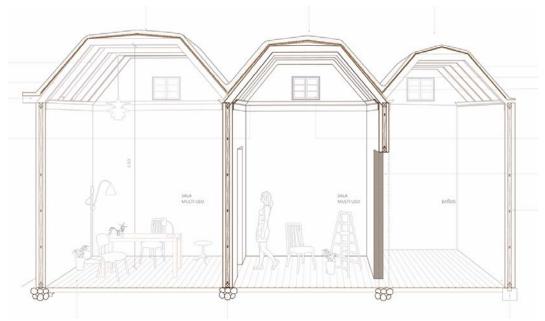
Corte proyectado de mojinetes Casa Copaja. (Elaboración: M. J. Cáceres)
